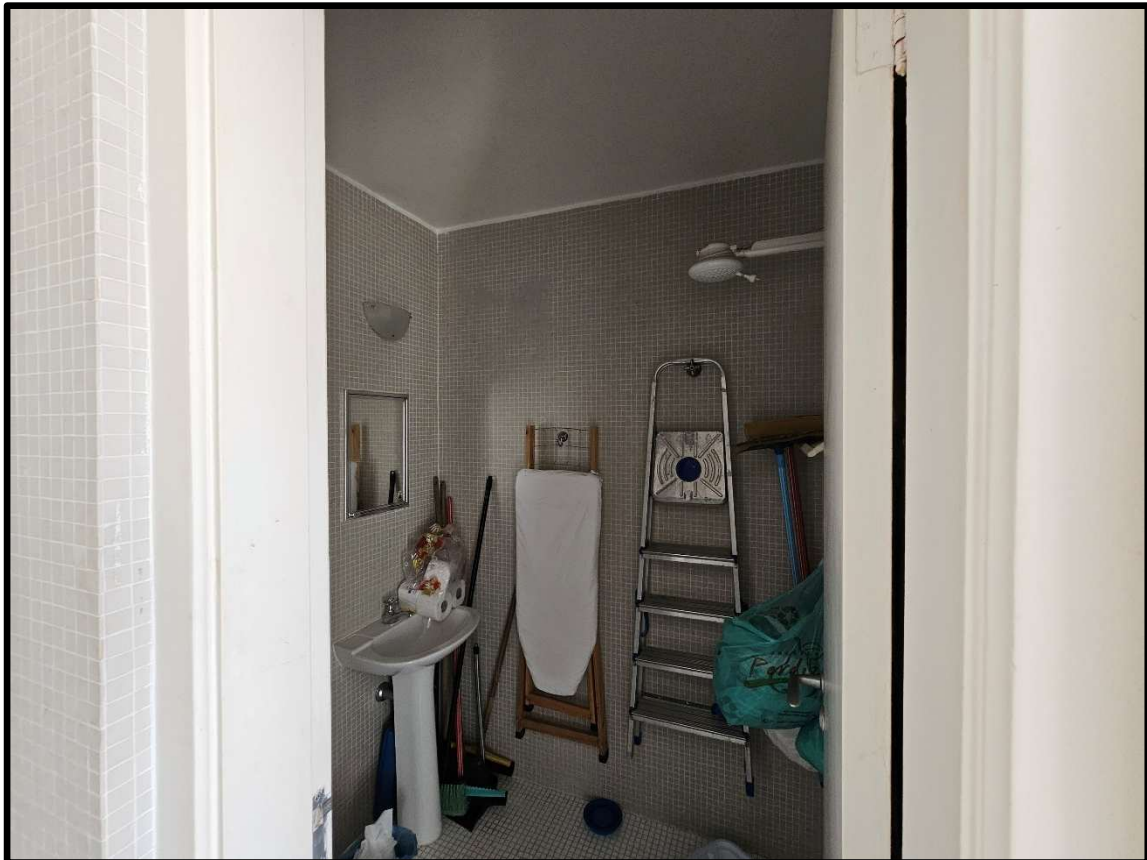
Banheiro - Área de Serviço (1º Pavimento)
